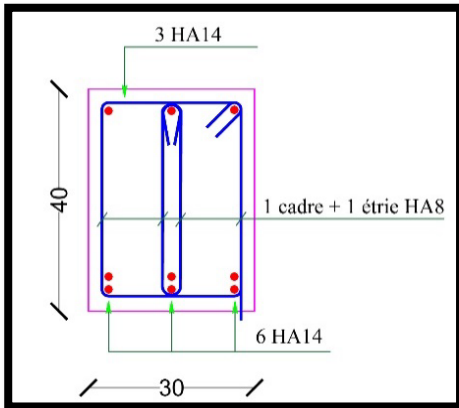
Ferrailage de poutre secondaire en appuis
